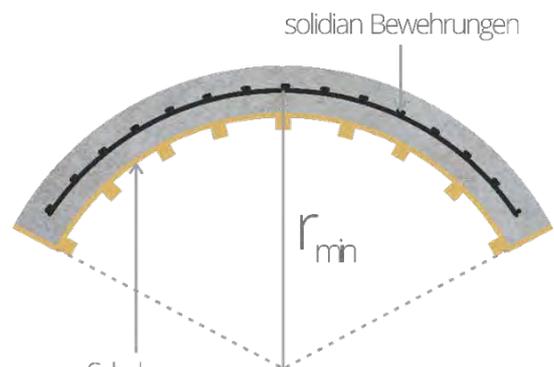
Einbau nur unter Beachtung des minimal zulässigen Krümmungsradius
